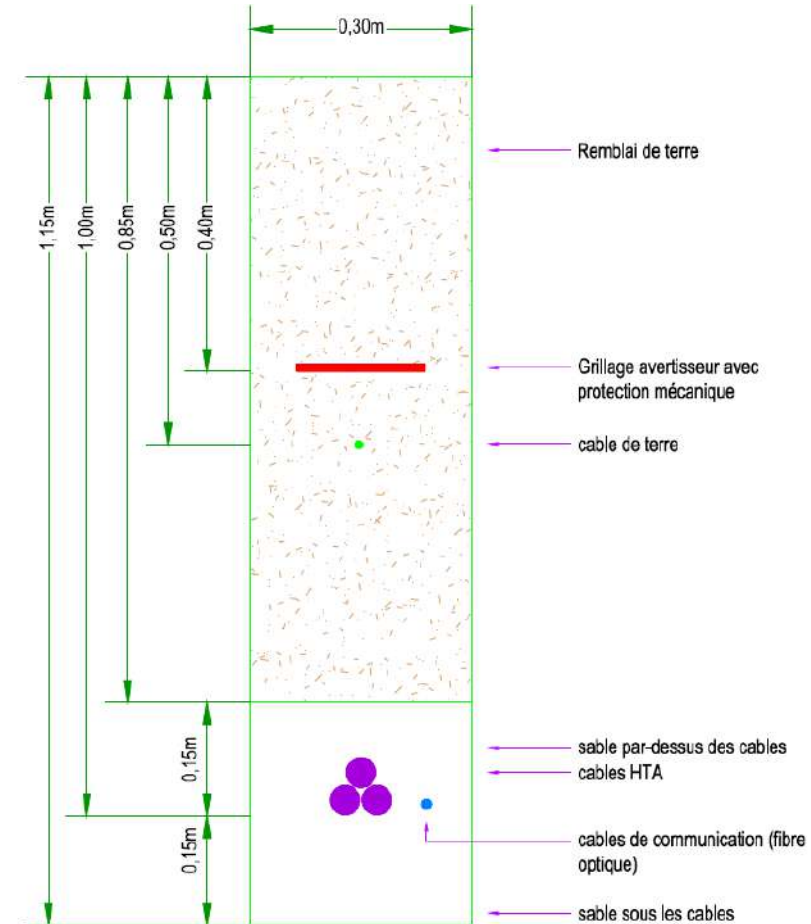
coupe d'une tranchée pour implantation des câbles au sein du projet
